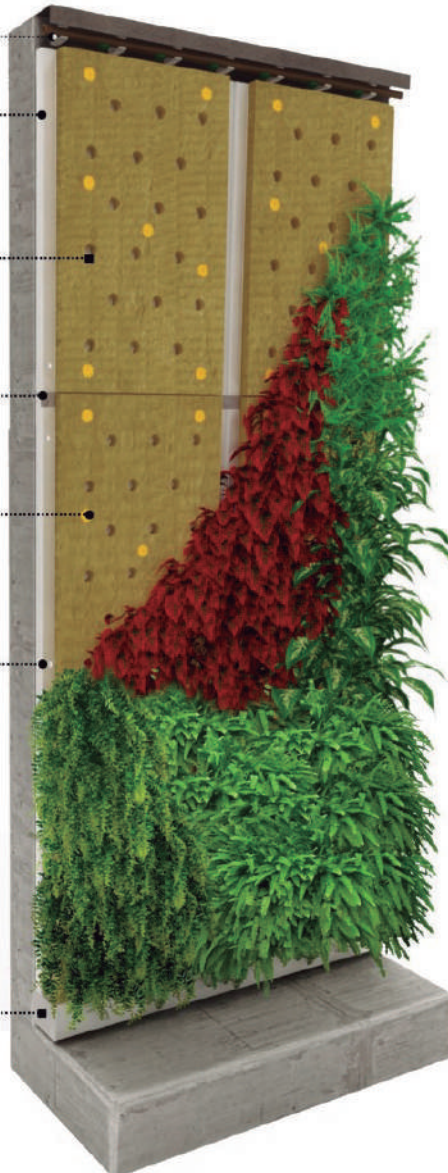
Sistema de Jardín Vertical F+P (fachada modular), de gran ligereza, alrededor de 50 kg/m² y plantación de 30 ud/m². Adecuado para exterior e interior. Fuente: Singular Green.
